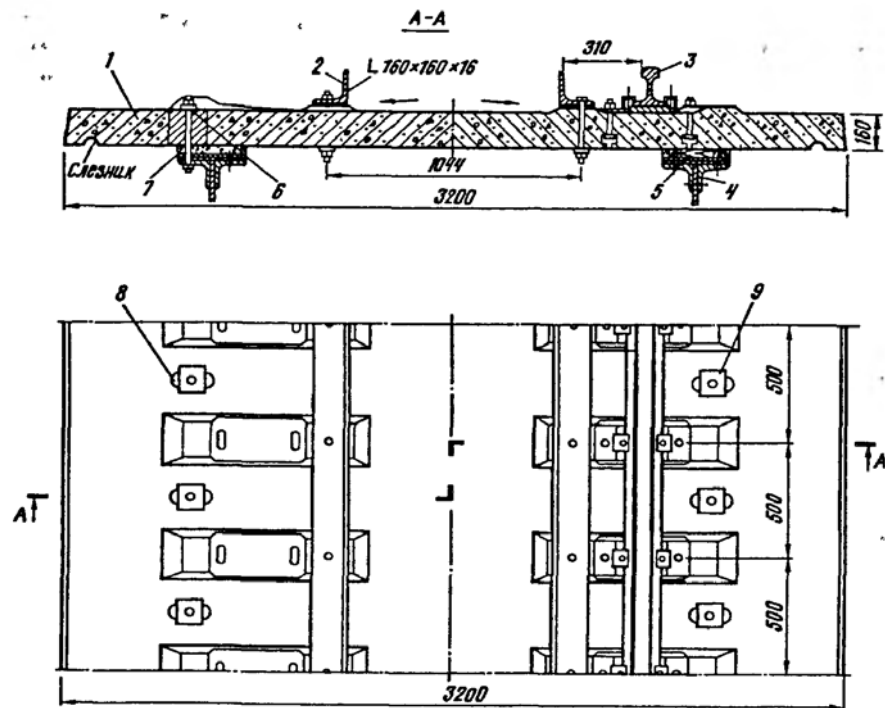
Мостовое полотно на безбалластных железобетонных плитах: 1 — безбалластная железобетонная плита; 2 — контуролок; 3 — путьевой рельс со скреплениями; 4 — главные балки; 5 — опорная деревянная прокладка; 6 — высокопрочная шпилька крепления плиты; 7 — цементно-песчаная подливка; 8 — овальное отверстие для шпильки и нагнетания раствора под плиту; 9 — шайбы
